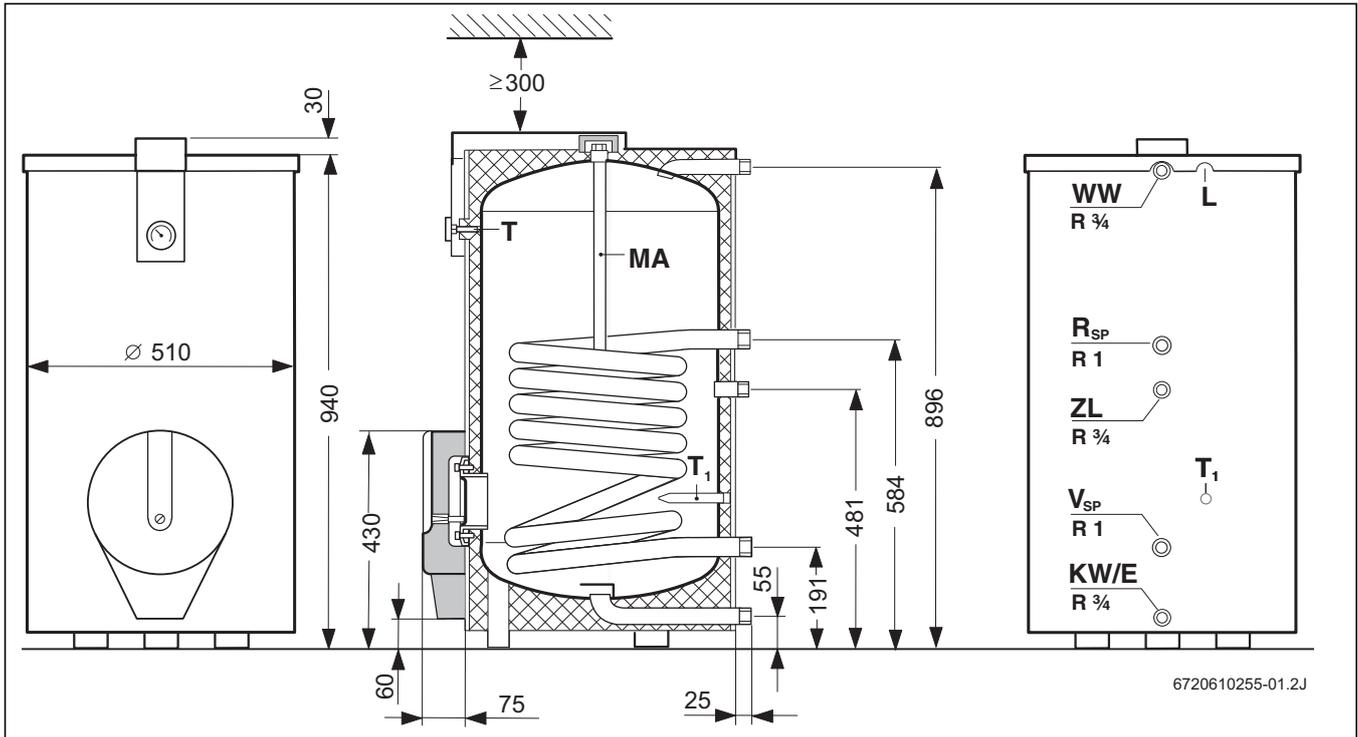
Bau- und Anschlussmaße SK 120-5 ZB
